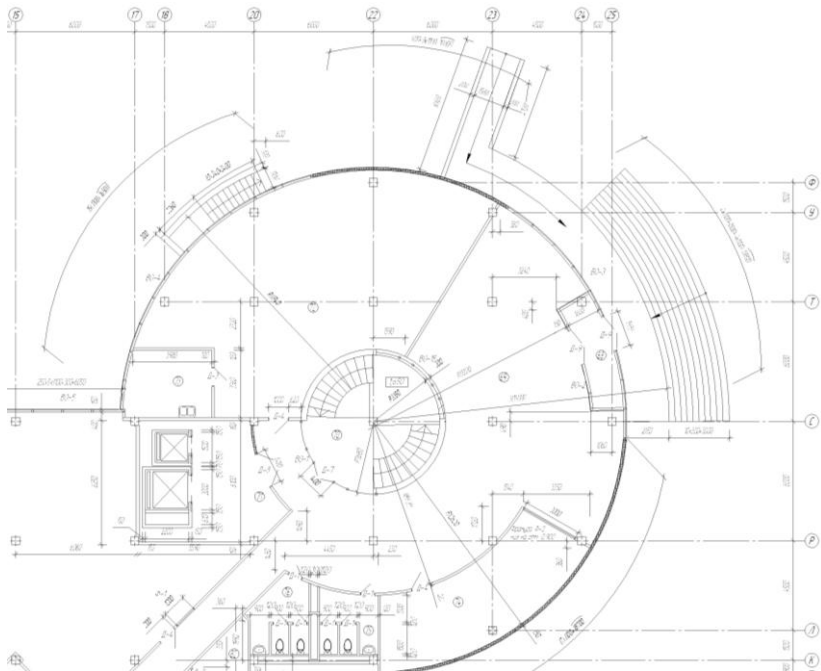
План першого поверху блока А будівлі бізнес-центру
